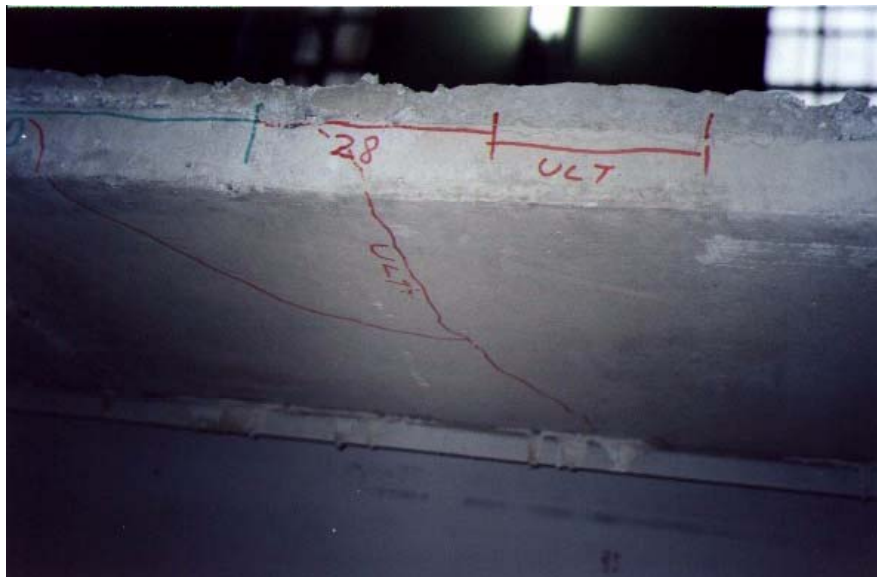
Fissuras na face inferior da pré-laje (Modelo 4).
